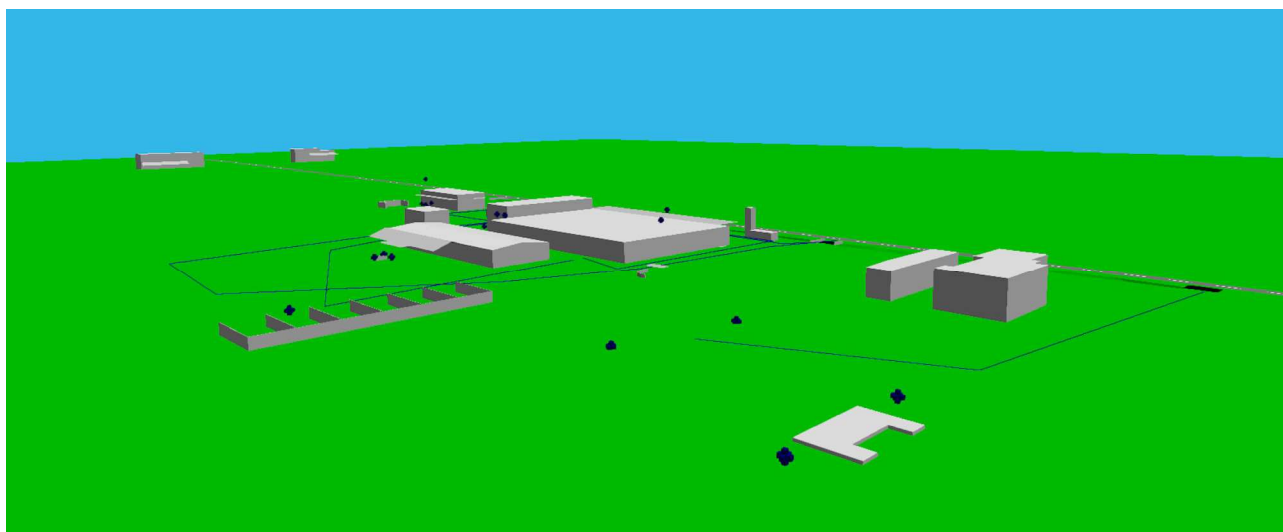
Vista Sud Ovest Cantiere SUD
